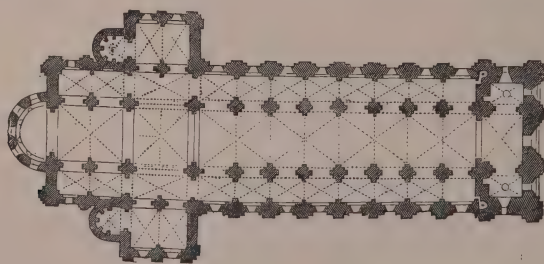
Pianta della chiesa di S. Stefano a Caen.
